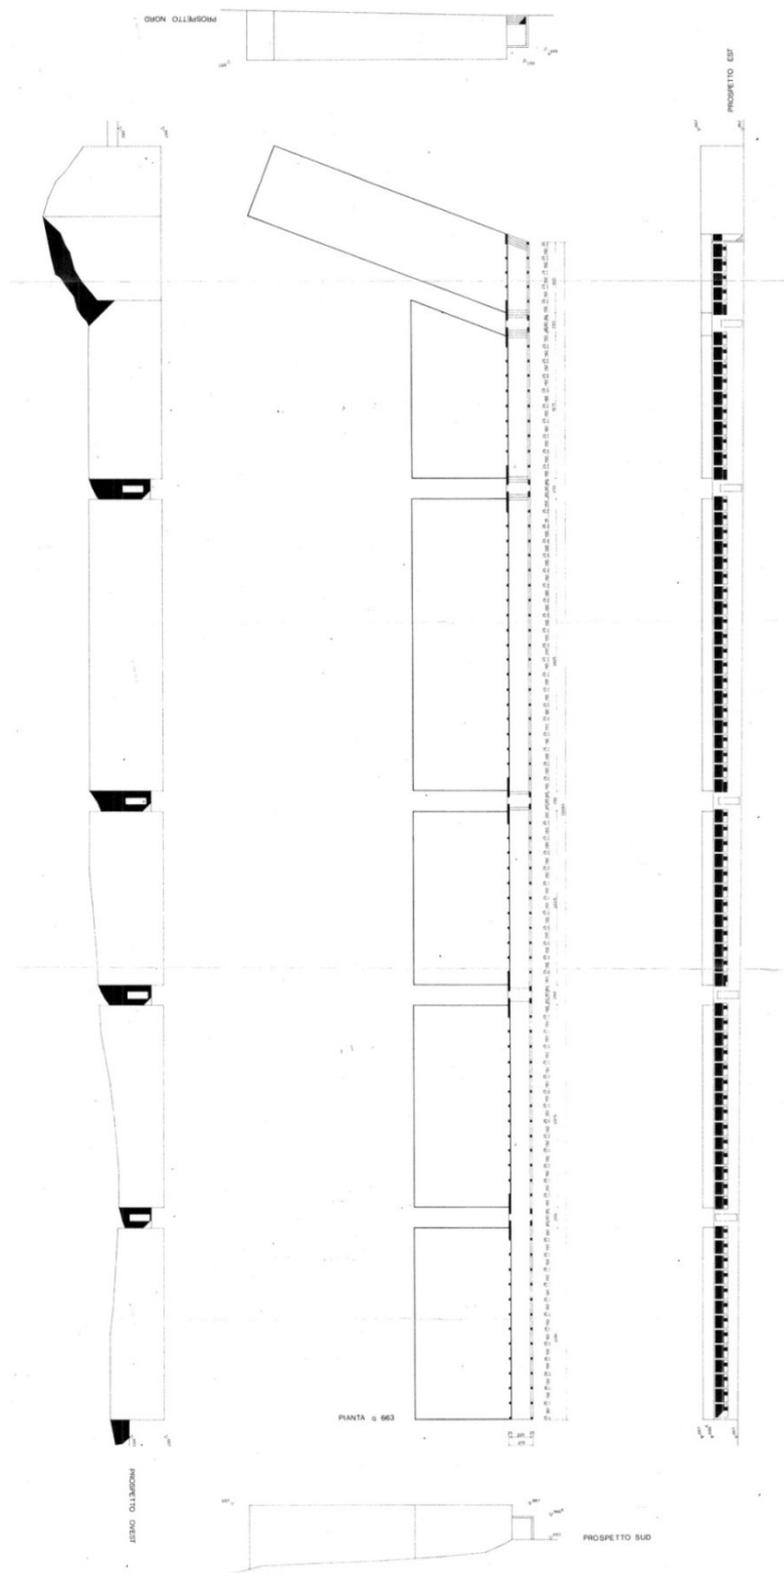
Piano di Recupero di Teora: progetto del porticato su Corso Plebiscito (piante e prospetti)
